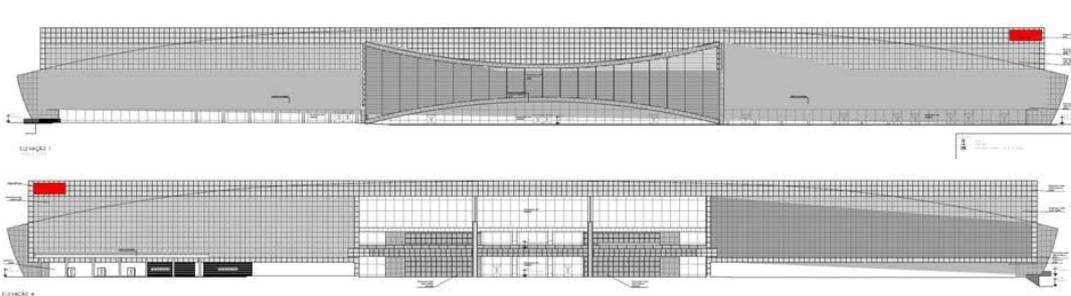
Proposta original de alteração das fachadas do CCUG.
